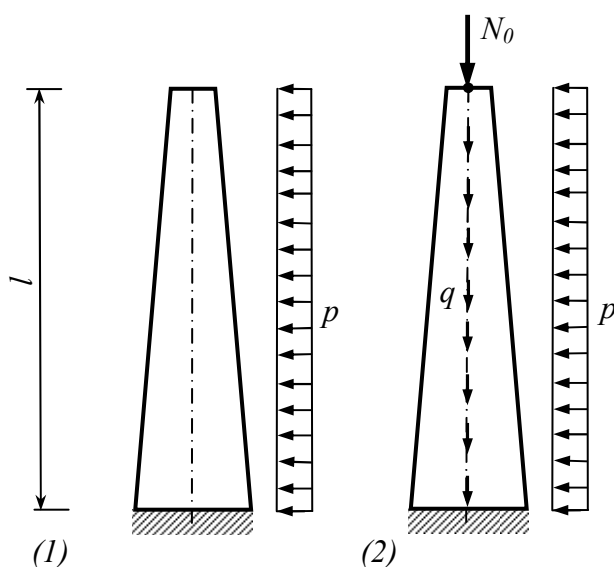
Расчетные модели конструкции решетчатой башни:
